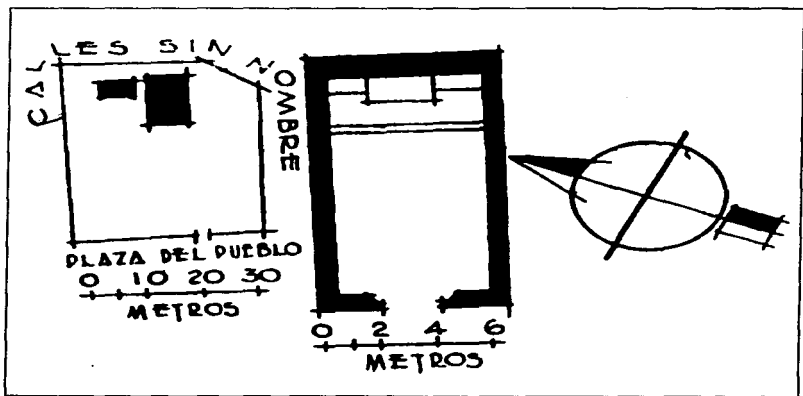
(03) Planta de la Capilla de San Juan Bautista en Teyahuala, Mpo. de Tepehuacán, estado de Hidalgo, 1894.
